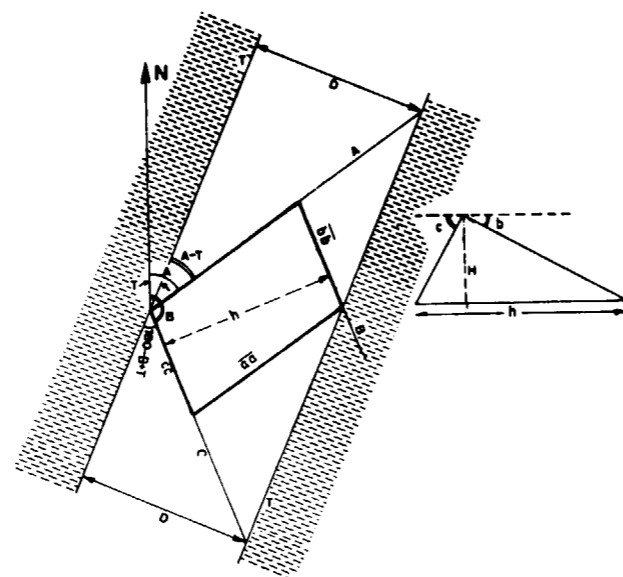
Planta en la clave (con bóveda plana) y sección transversal a la intersección horizontal de un prisma triangular.
